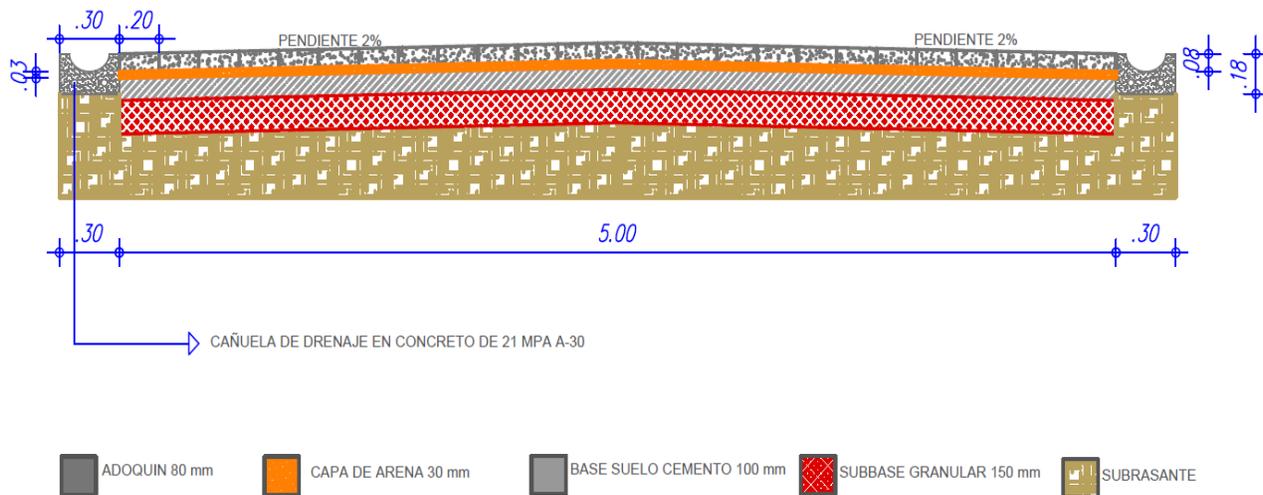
1: Estructura de pavimento articulado metodología Ing. Alfonso Montejo. Tomado propio.
